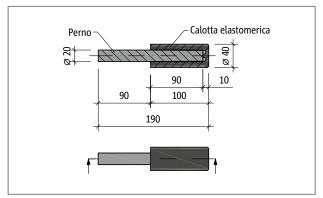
Schöck Tronsole® tipo D: pianta del prodotto
